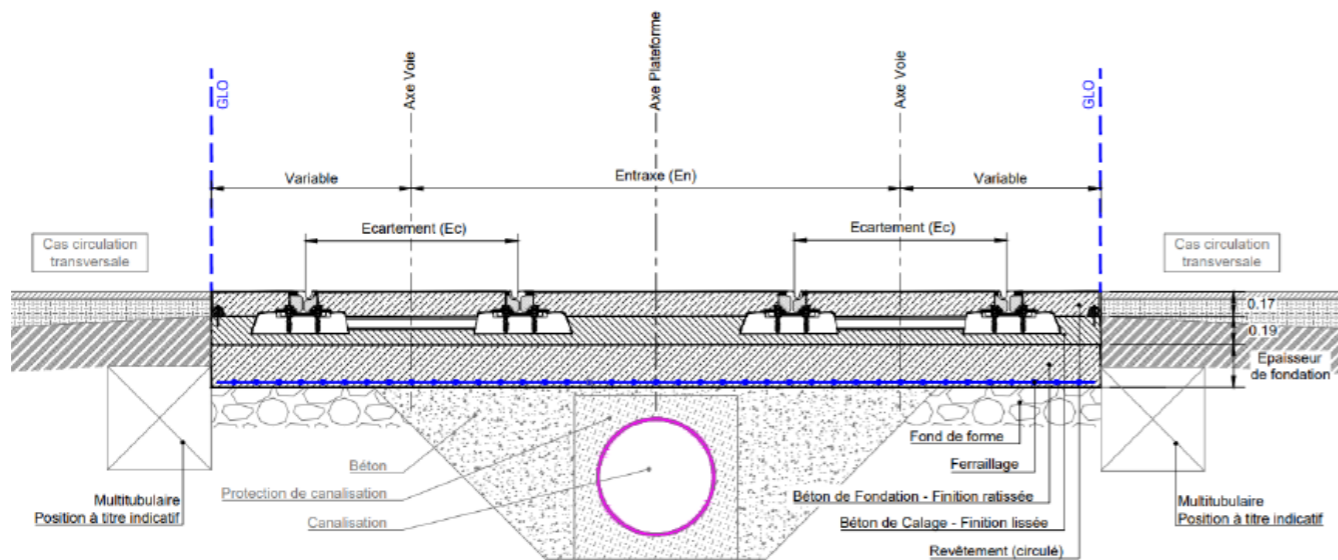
coupe transversale de plateforme sur zone de pontage d'un réseau longitudinal.
